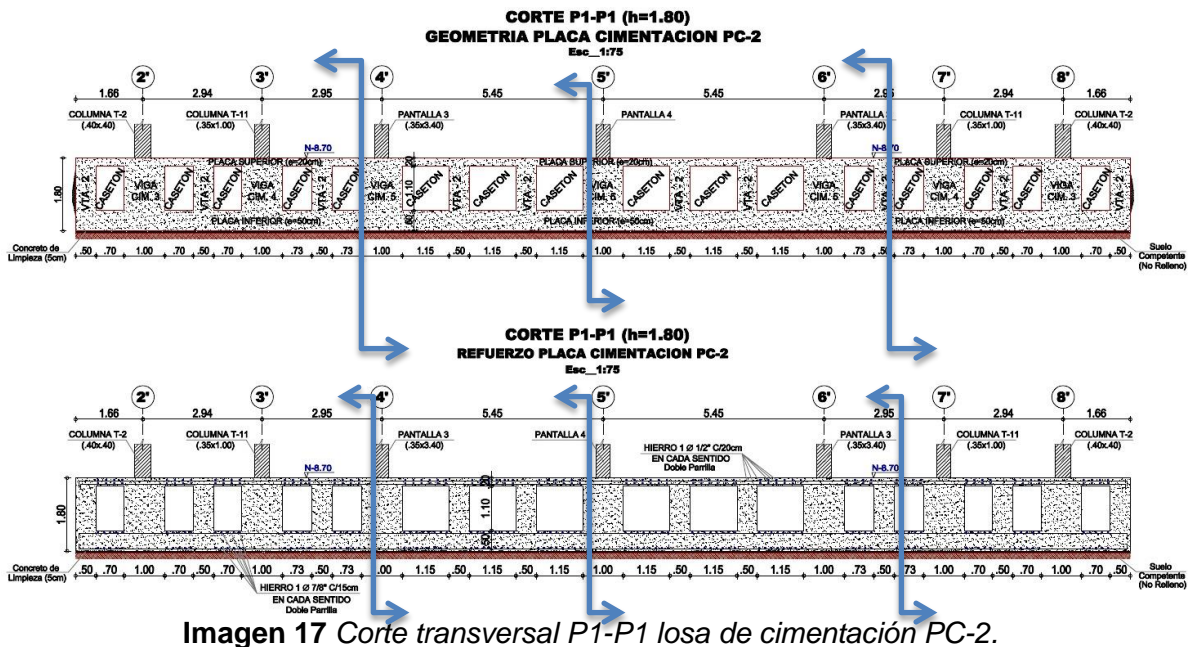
Corte transversal P1-P1 losa de cimentación PC-2.
